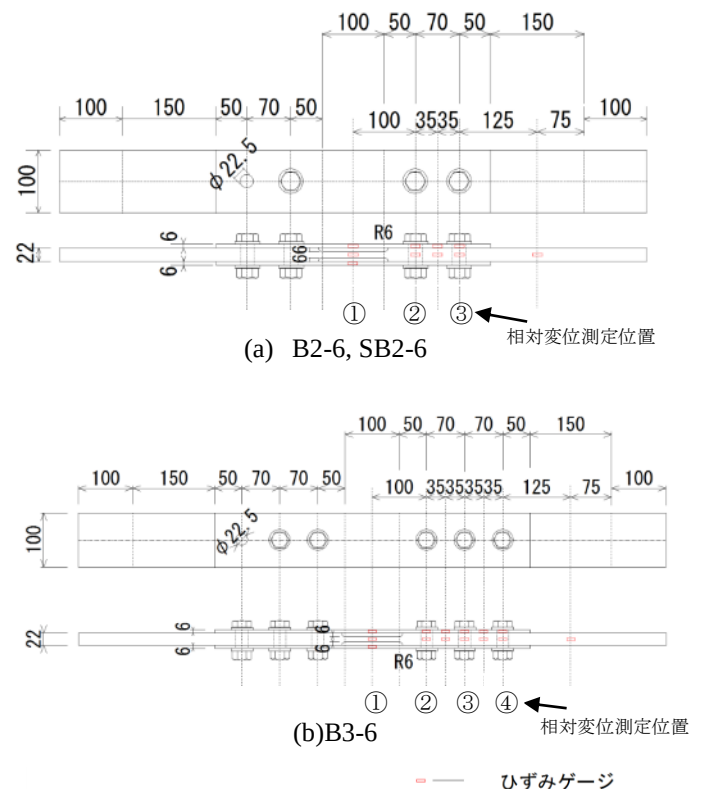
供試体の形状とひずみ計測位置 (単位: mm)
